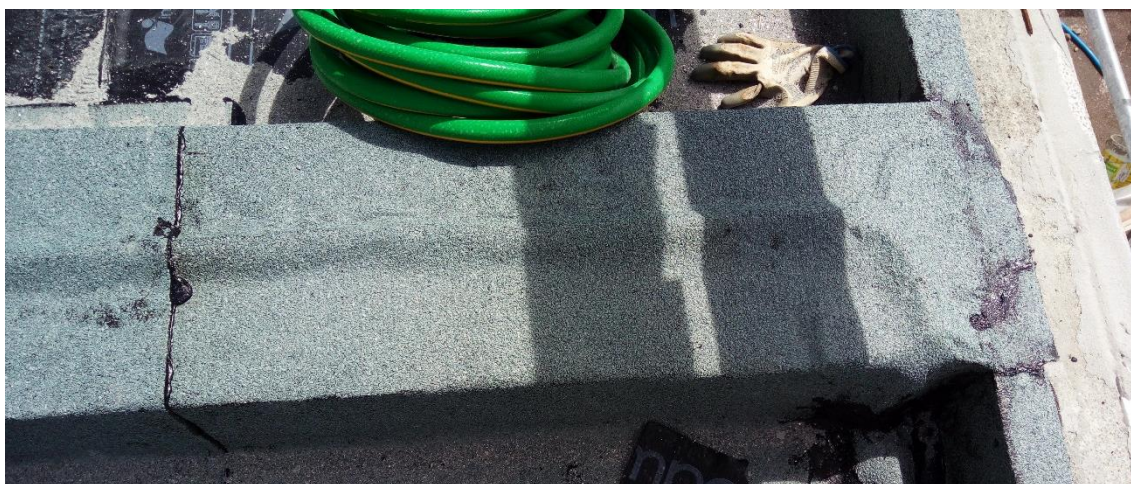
Pormenor da junta de dilatação (Fonte: Autor)
